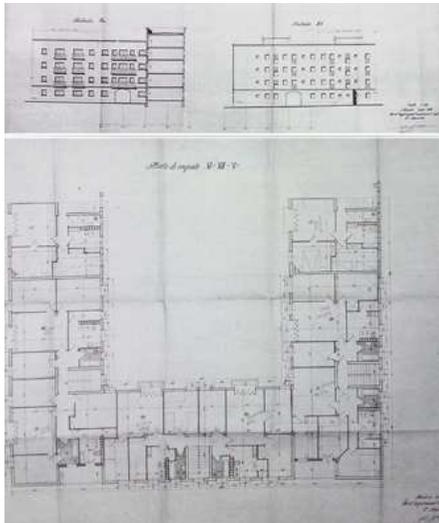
y 100. Colonia del Pilar. Planta general y Alzados. Madrid, 1944. Arq. L. Gámir (1ª fase).
